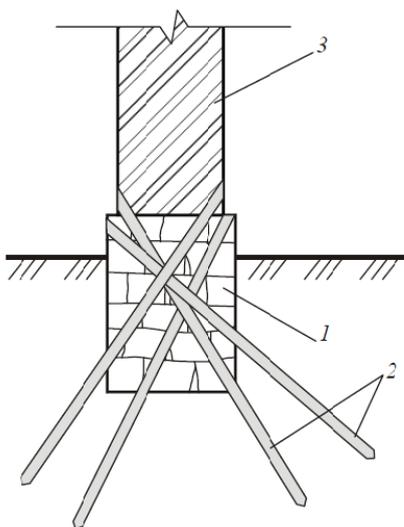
Усиление фундаментов буройнъекционными сваями: 1-фундамент; 2- буройнъекционные сваи; 3-стена
